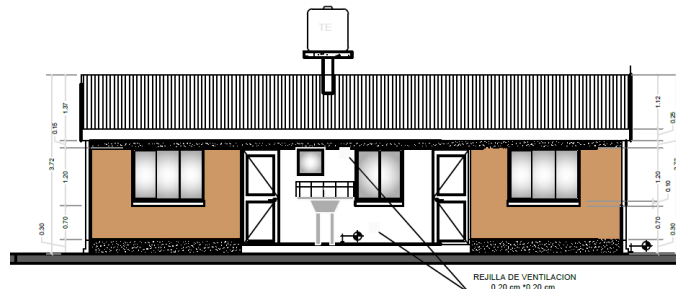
Planos Arquitectónico, Elevación Frontal.
